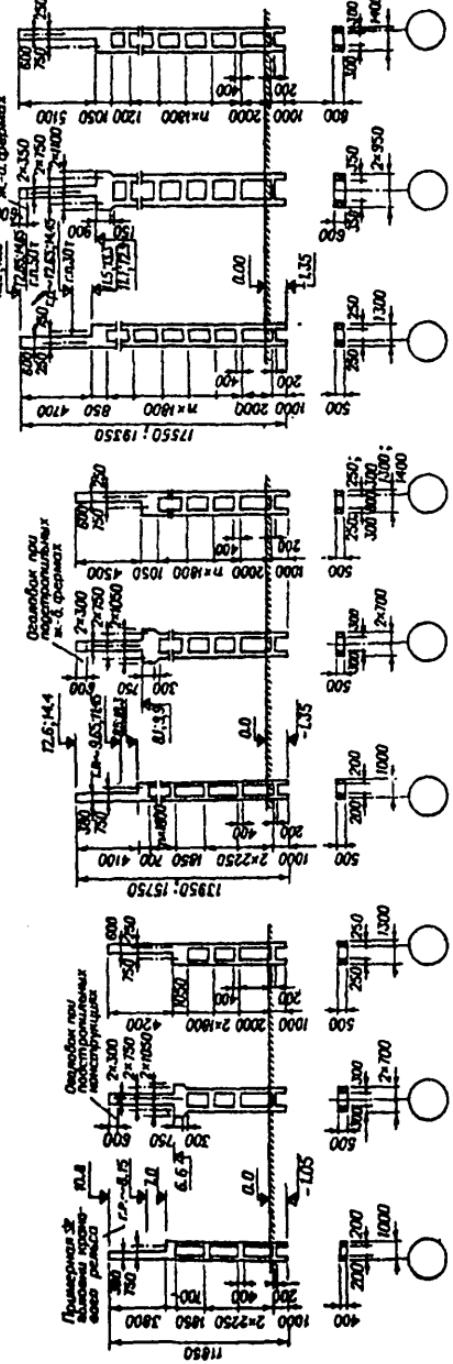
Железобетонные двухветвевые колонны для зданий с мостовыми кранами грузоподъемностью 10–50 т
